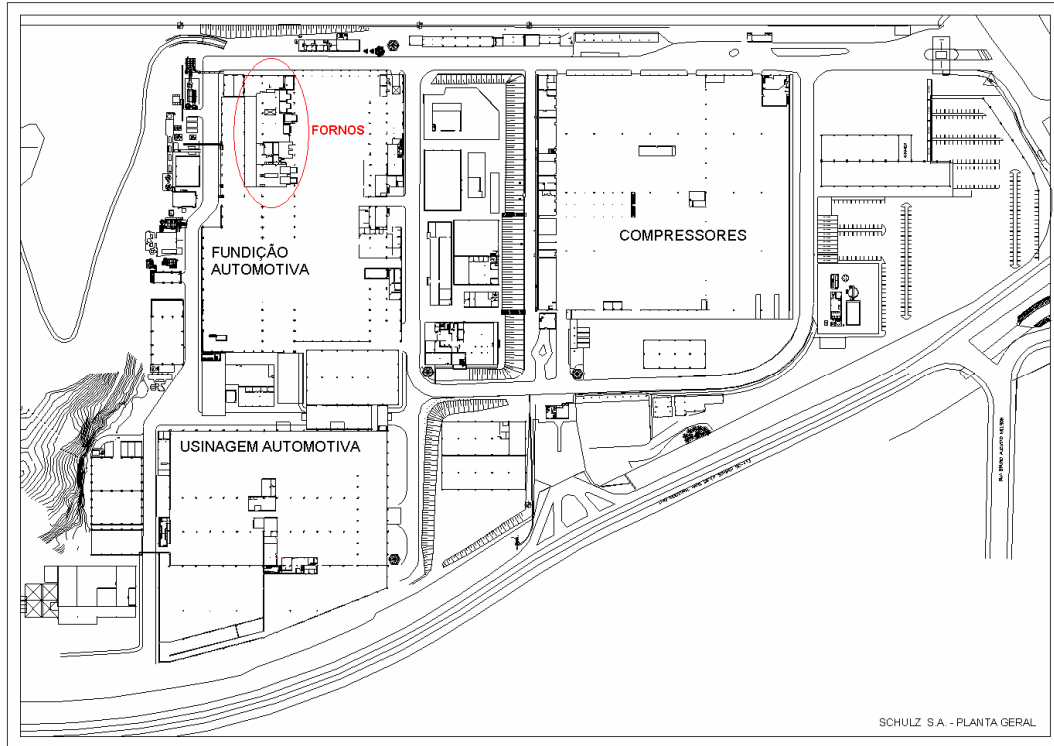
Layout da empresa, com destaque para a área em estudo (fornos da fundição).
